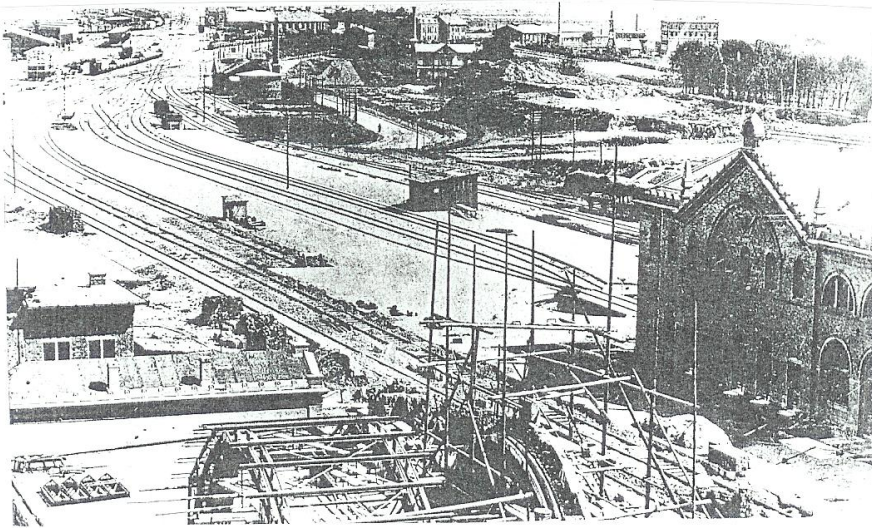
Erfurt: Hauptbahnhof. Von Eduard Keil und Otto Eriksen, 1887-93. Eisenkonstruktionen.
